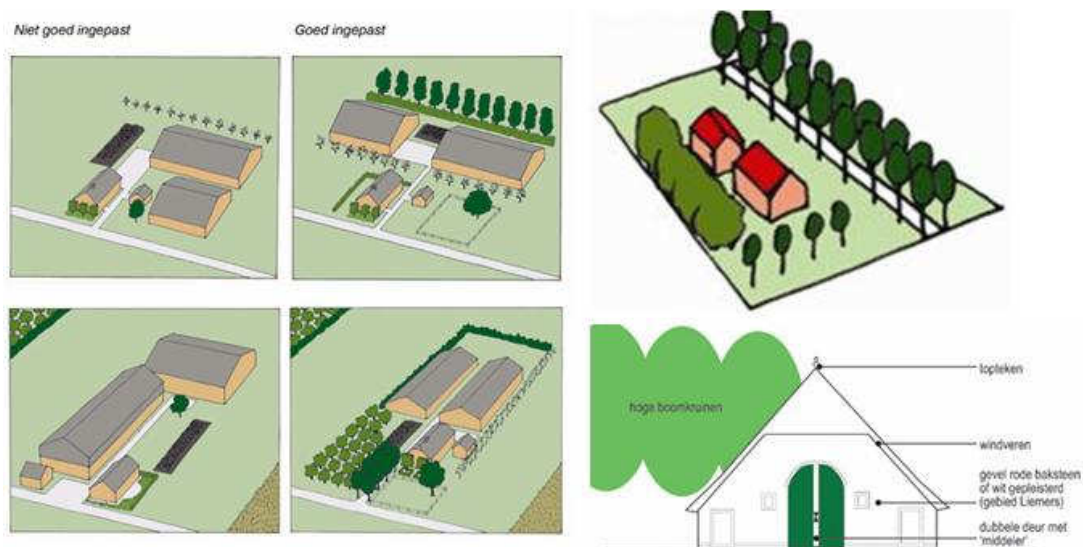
Ruimtelijk kader bestemmingsplan
